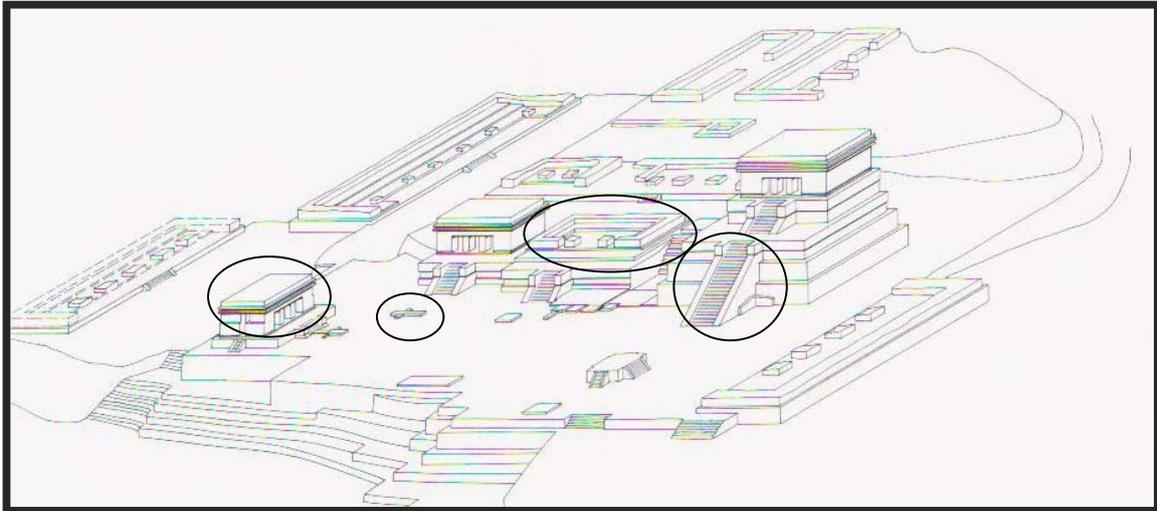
Isométrico de Topoxté. Reconstrucción hipotética de Noriega. Note las escalinatas exentas con alfardas y dados, los edificios de planta tipo “C”, las losas planas y las plataforma-altar de planta cruciforme (Tomado de Wurster, 2000).
